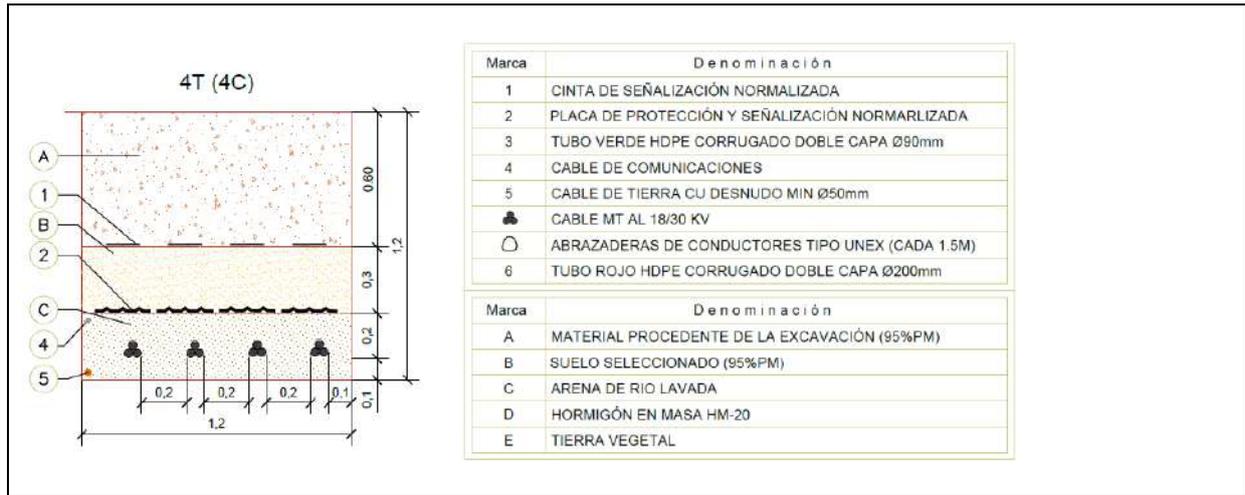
Detalle Sección Zanjas Tipo 4T. Conductor directamente enterrado
